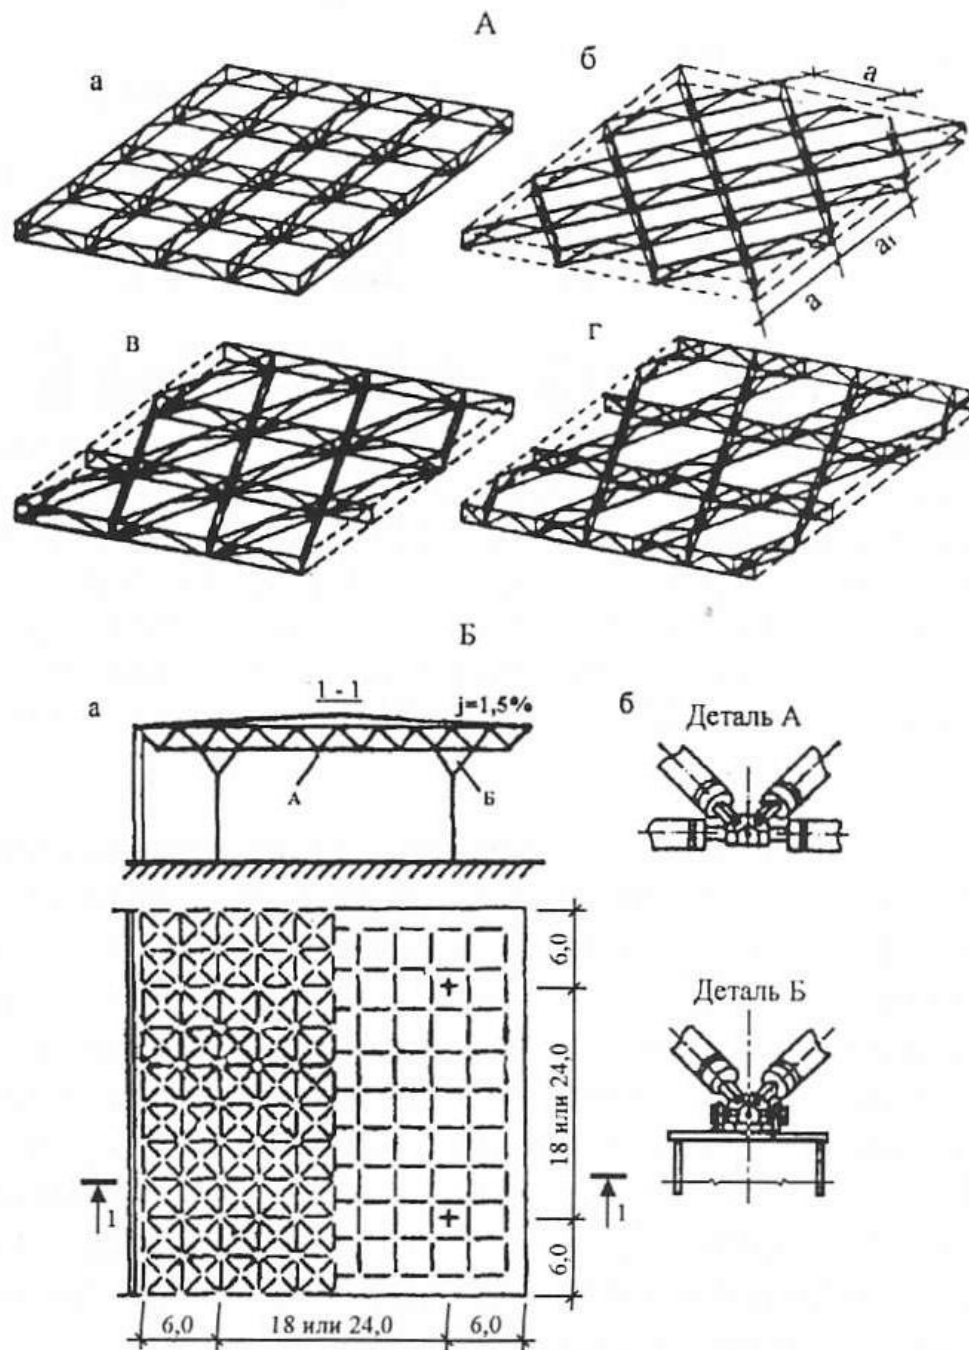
Перекрестно-ребристые и перекрестно-стержневые перекрытия: А – из вертикальных перекрестных ферм, а, б – при расположении ферм в двух направлениях; в, г – при расположении ферм в трех направлениях; Б – из стержневых дисков (поясных секток) и пространственной решетки между ними, а – разрез и план квадратного перекрытия с консолями; б – схема узлов
